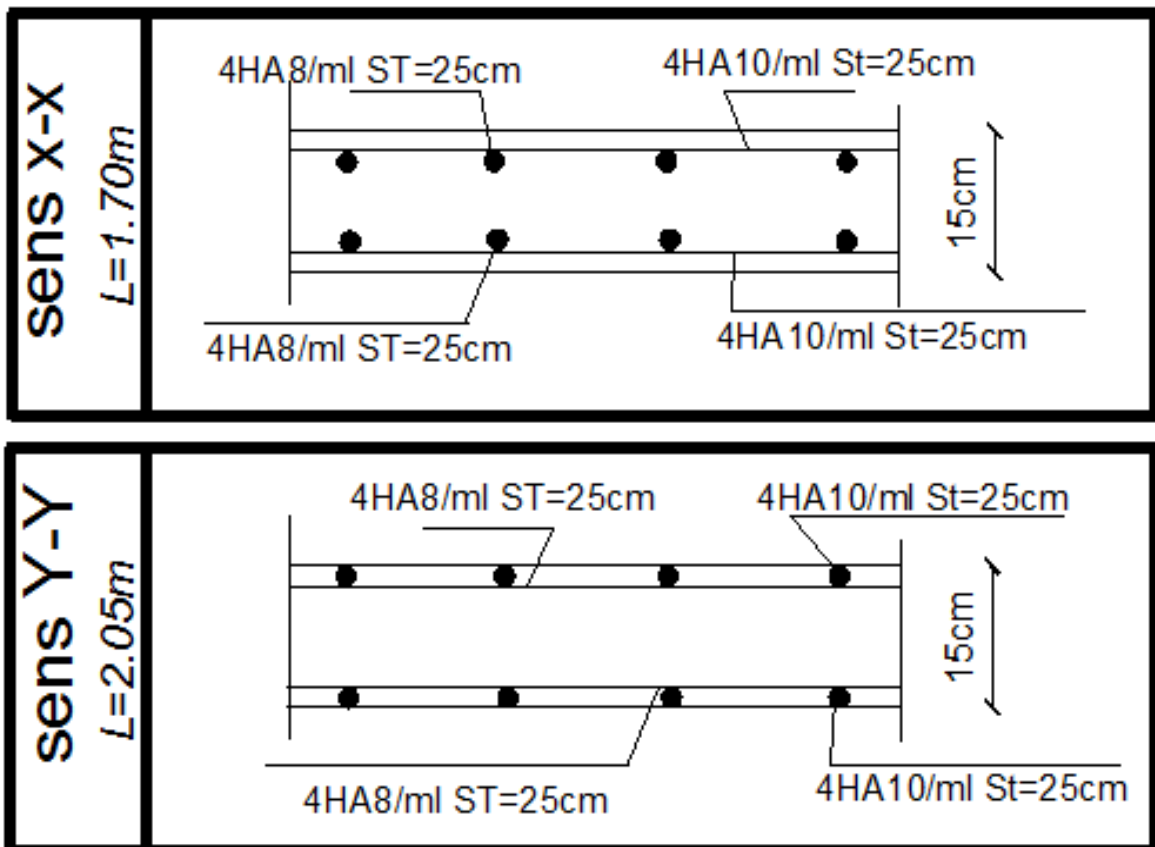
schéma de ferrailage de la dalle salle machine.
